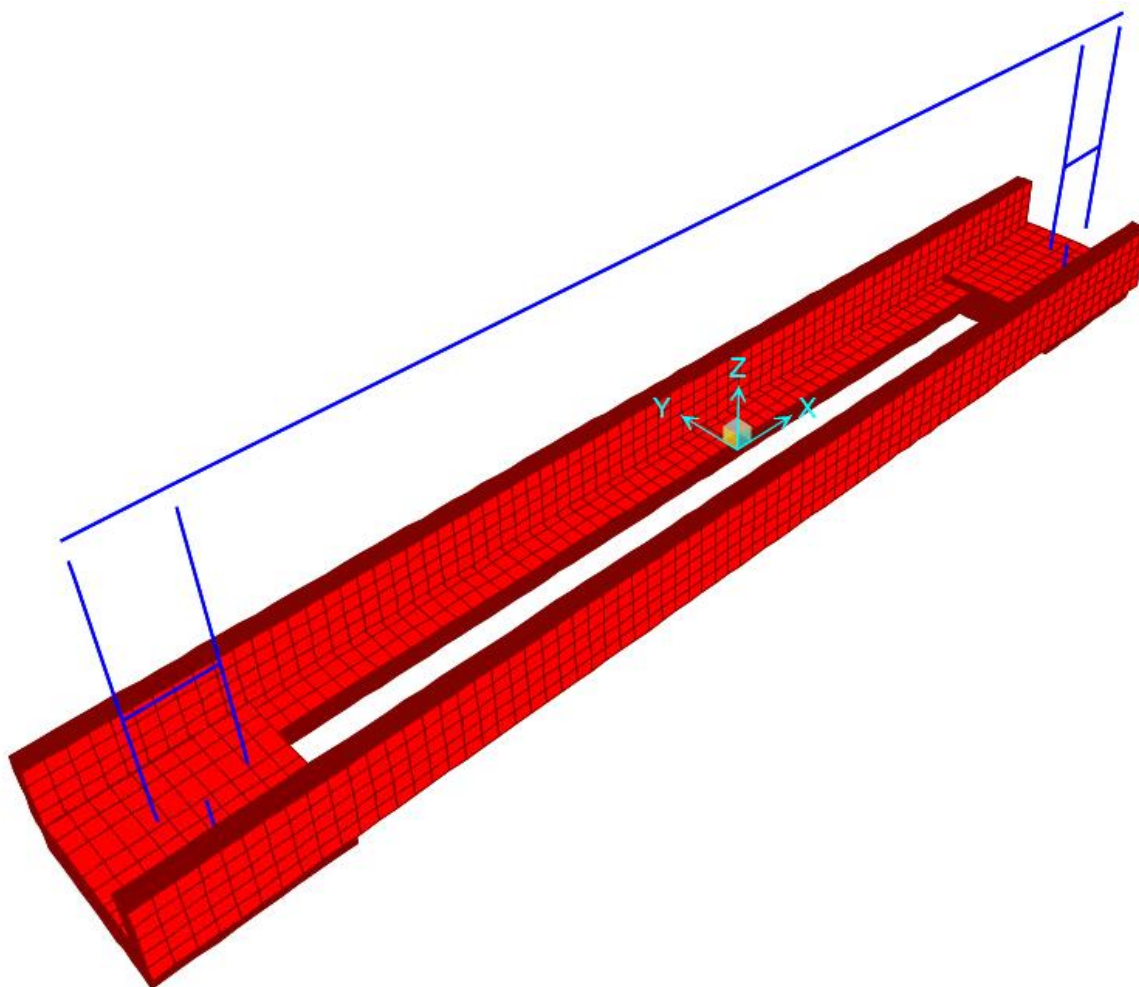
Modello 3D – Fondazione pensilina Laterale B=2m
